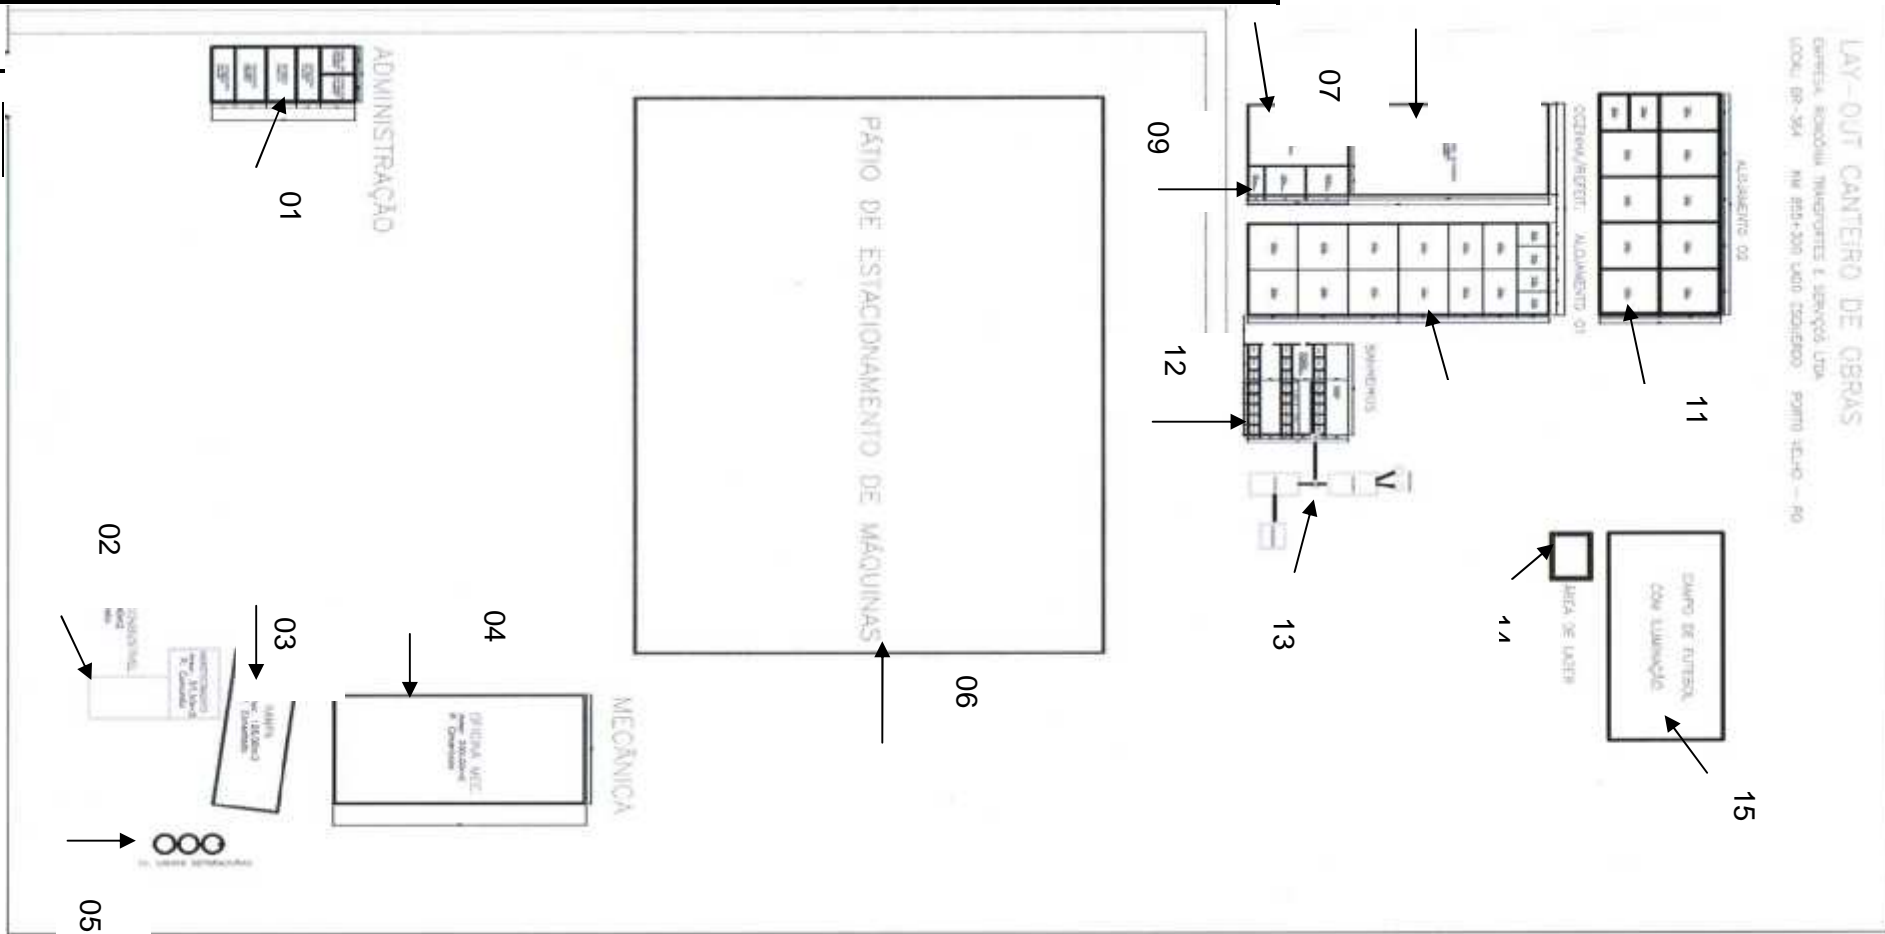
LAYOUT – CANTEIRO DE OBRAS
